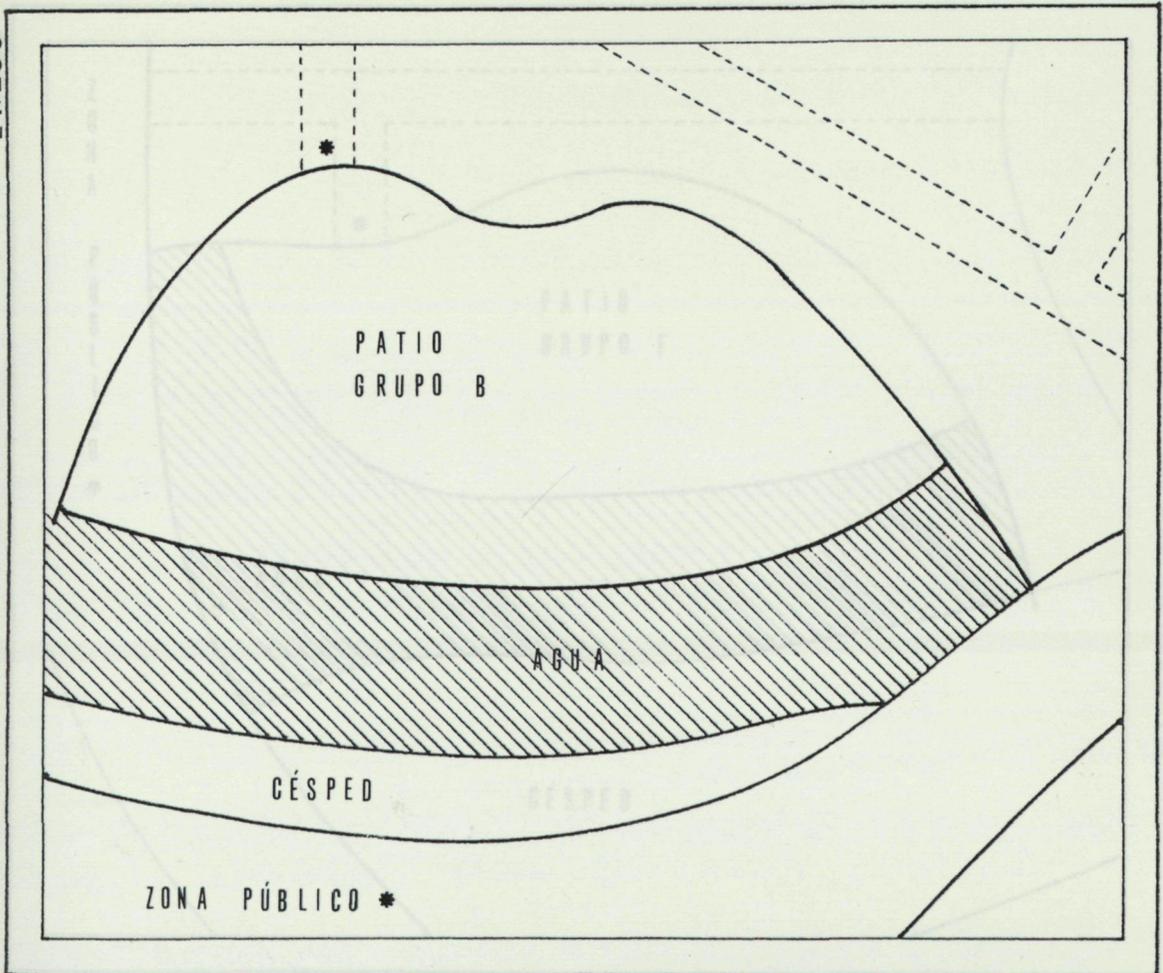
Planta de la instalación exterior del grupo B de chimpancés (Zoo de Barcelona). \*: puntos de observación.
